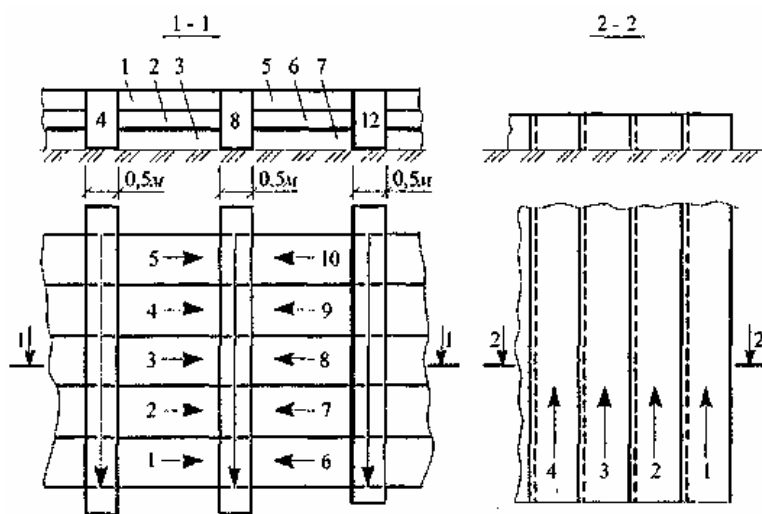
Схема разработки грунта бульдозером траншейным и послойным способами
